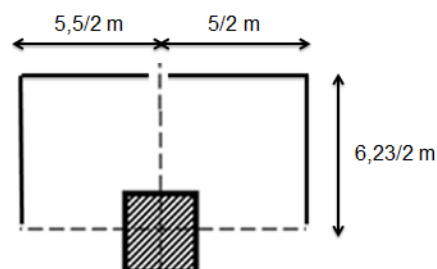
Section du poteau le plus sollicité du bloc E1 & E2
